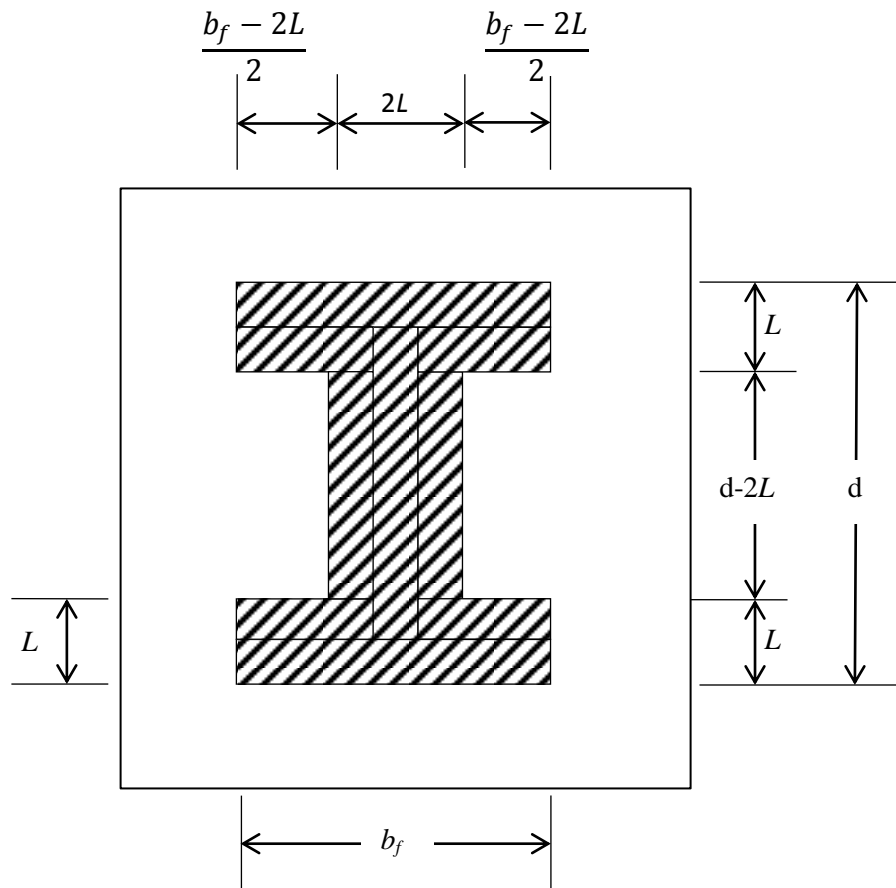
Distribución de la carga de la columna pequeña al concreto de soporte.
